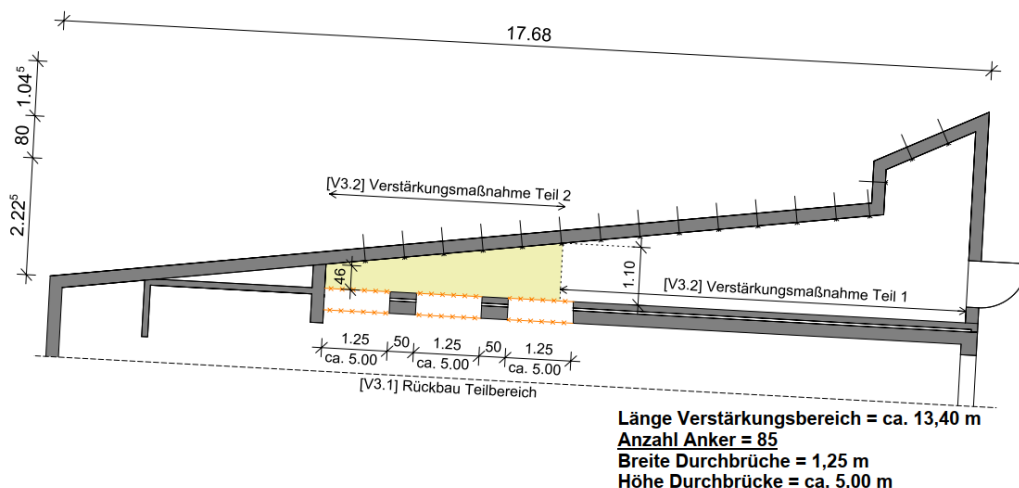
Grundriss Verstärkungsmaßnahme, Auszug aus Anlage 10
